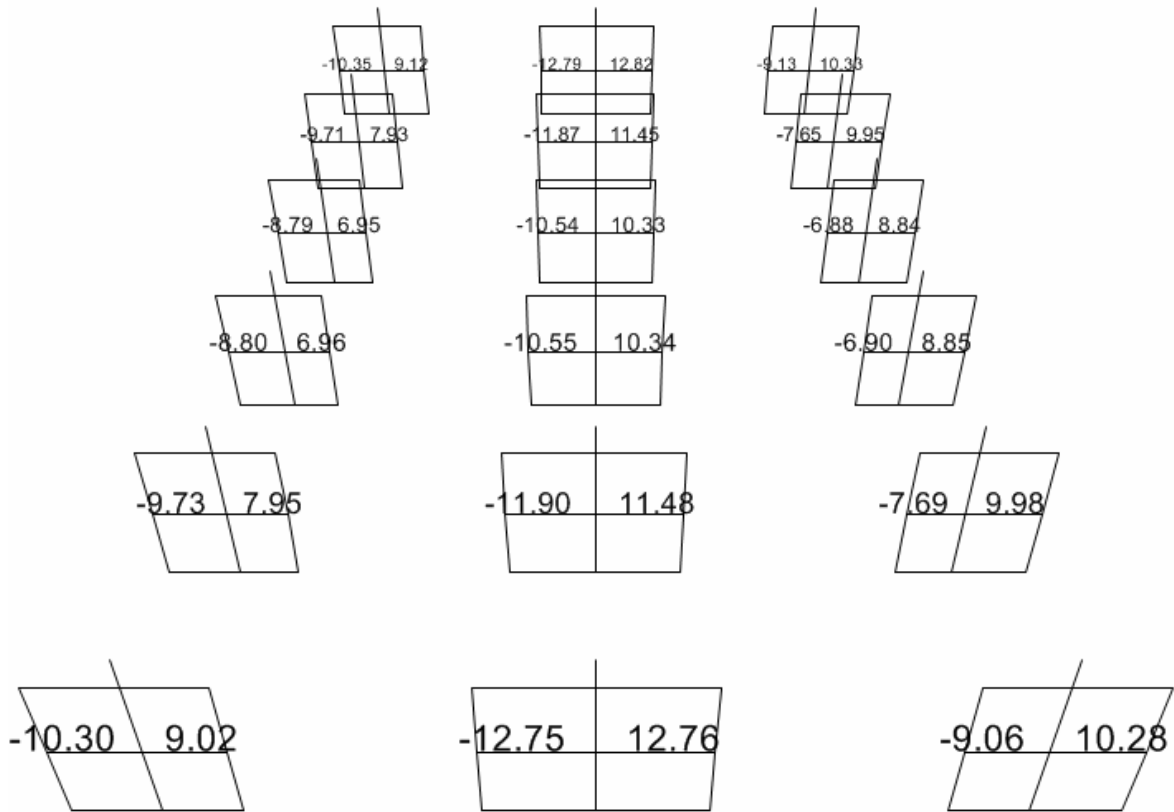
Se observan el cortante en la planta baja. Se puede notar que el cortante en las columnas es más pequeño que el modelo con planta baja débil.
